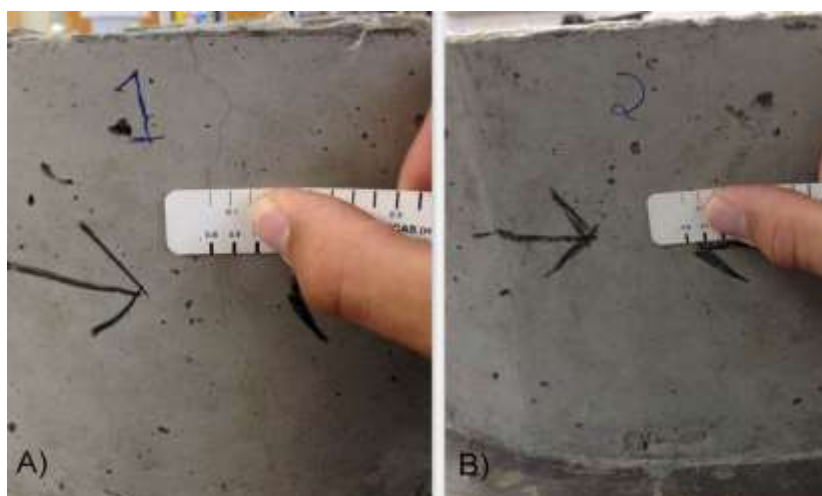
Fissuração da amostra CFU – 03 do concreto reforçado com fibra de poliéster usada
